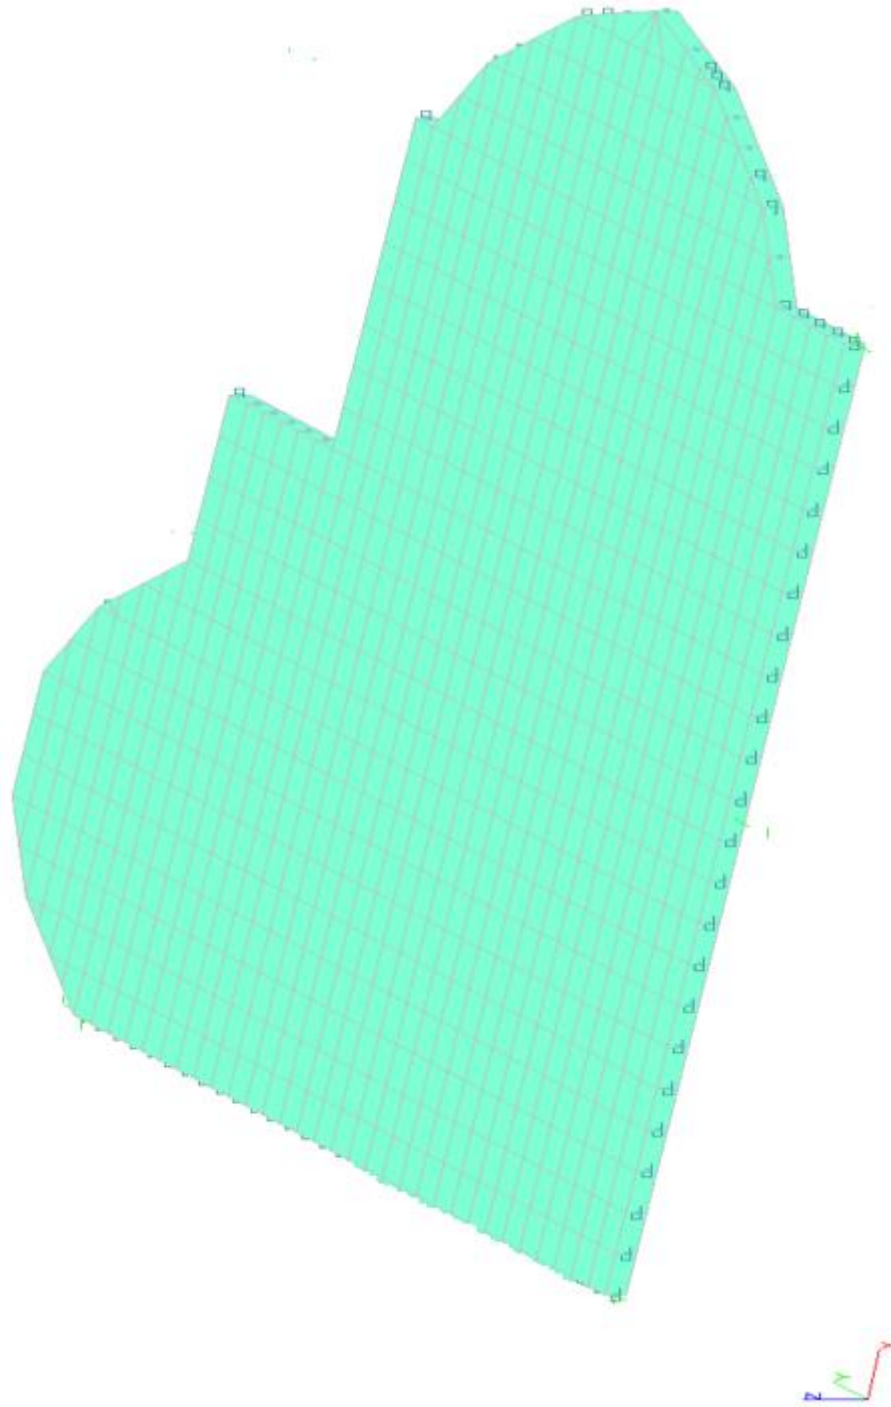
Расчетная схема плиты перекрытия в пространстве
